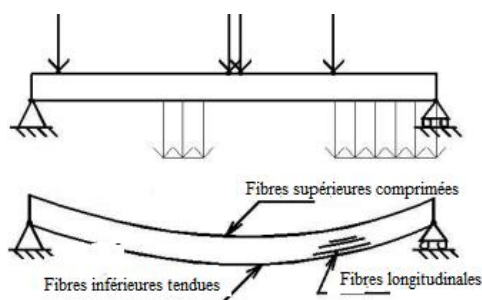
Déformation de la poutre sous un moment fléchissant
